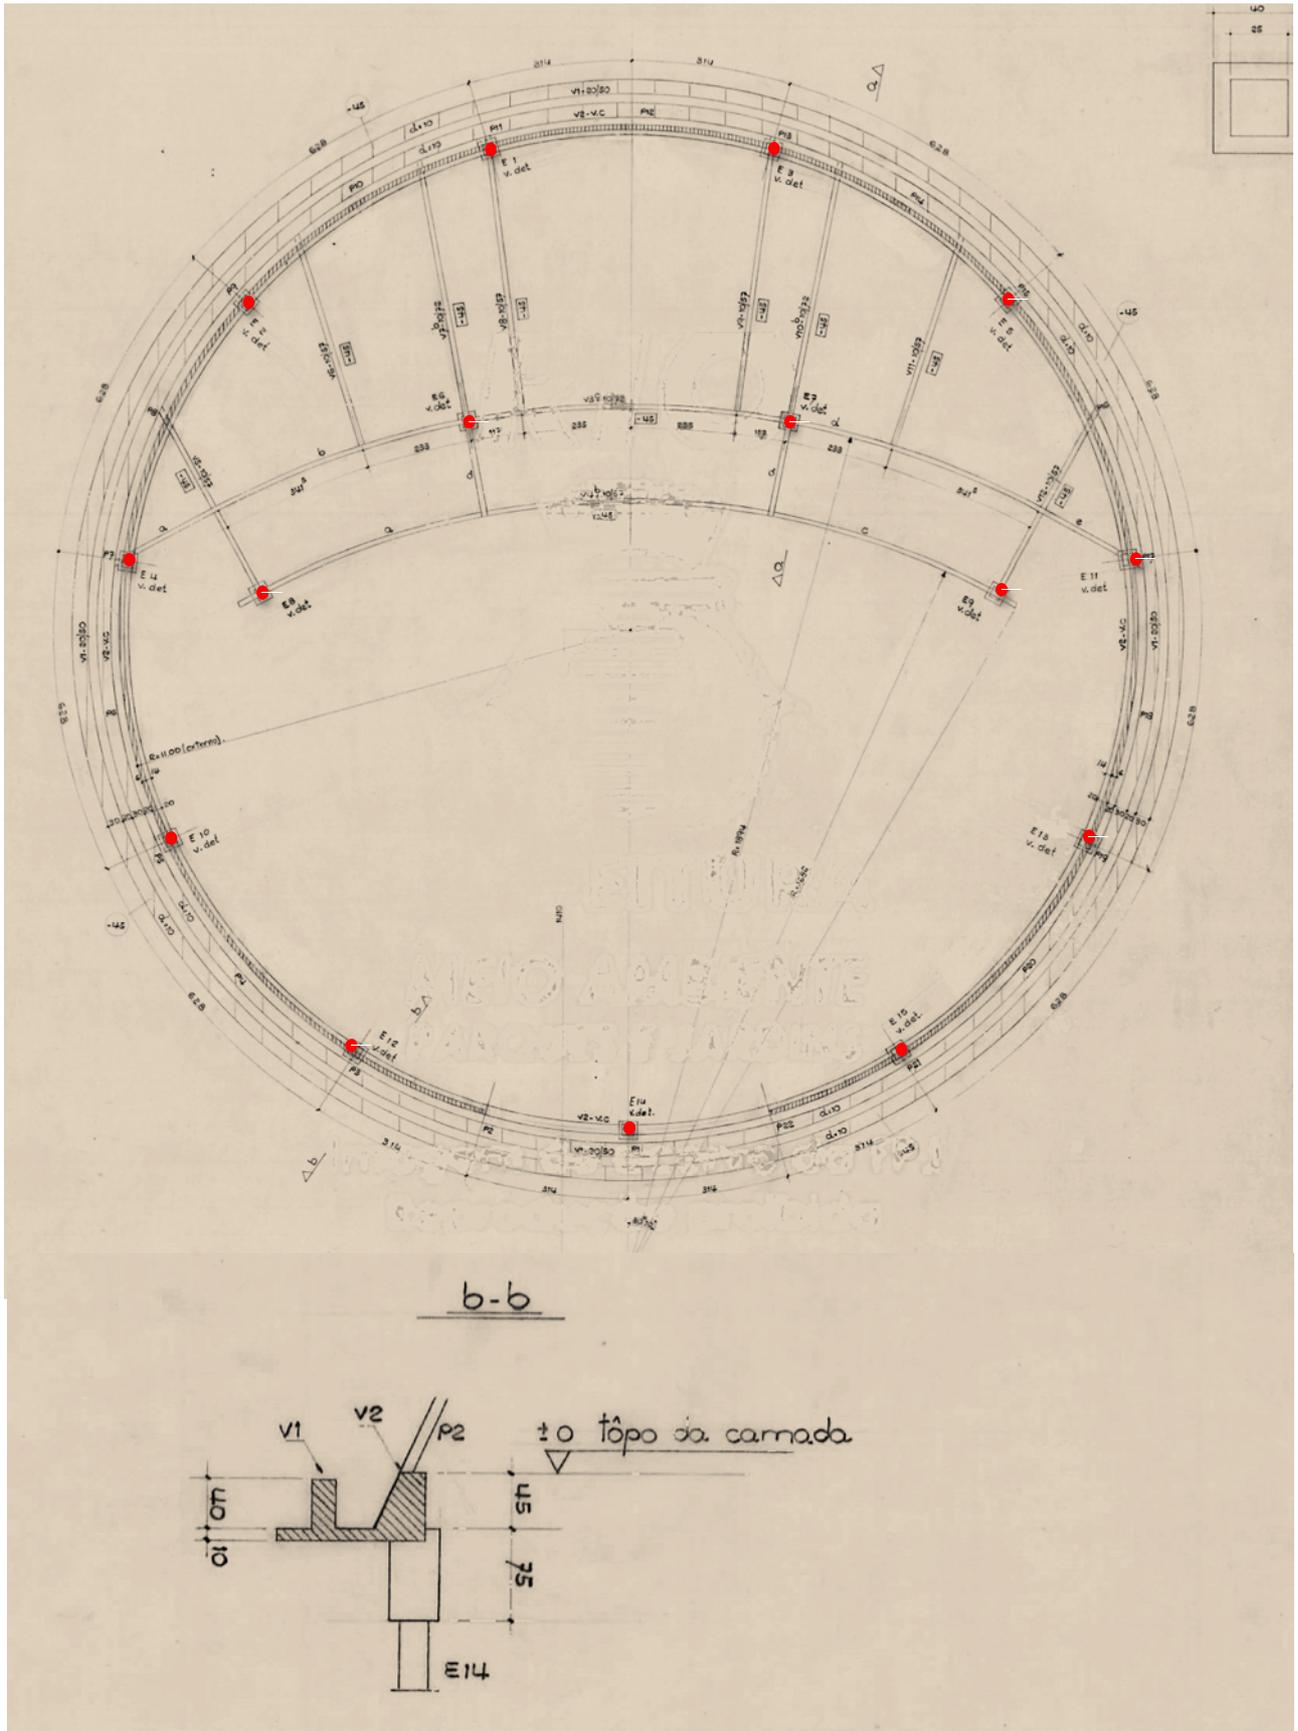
Planta de fundação e corte do anel de tração do Pavilhão do Morro da Viúva
